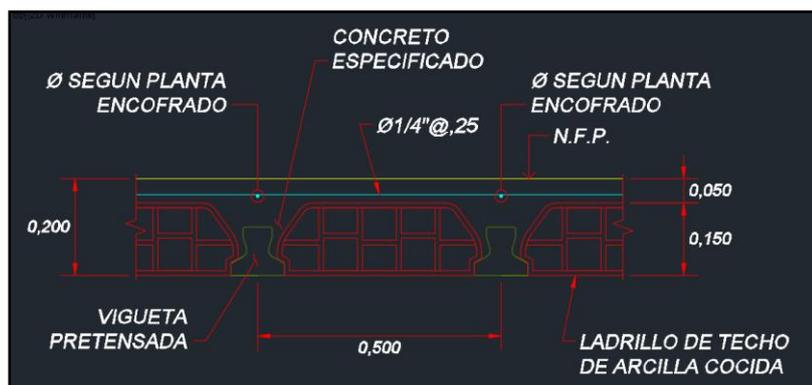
Detalle de losa aligerada con espesor de 20cm
